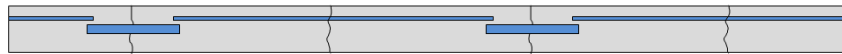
Esquema de pavimento de concreto simple con juntas
